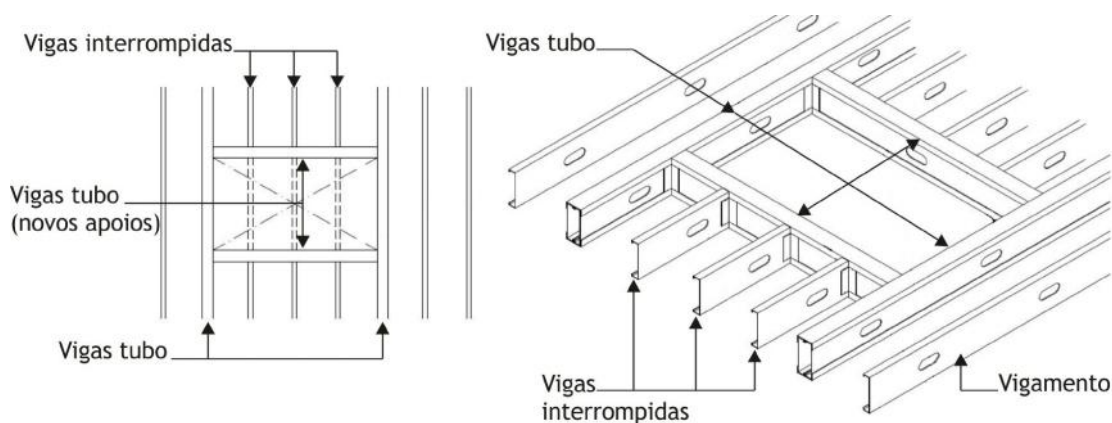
Abertura de vãos em lajes e elementos estruturais. Adaptado de: ConsulSteel, 2002.
